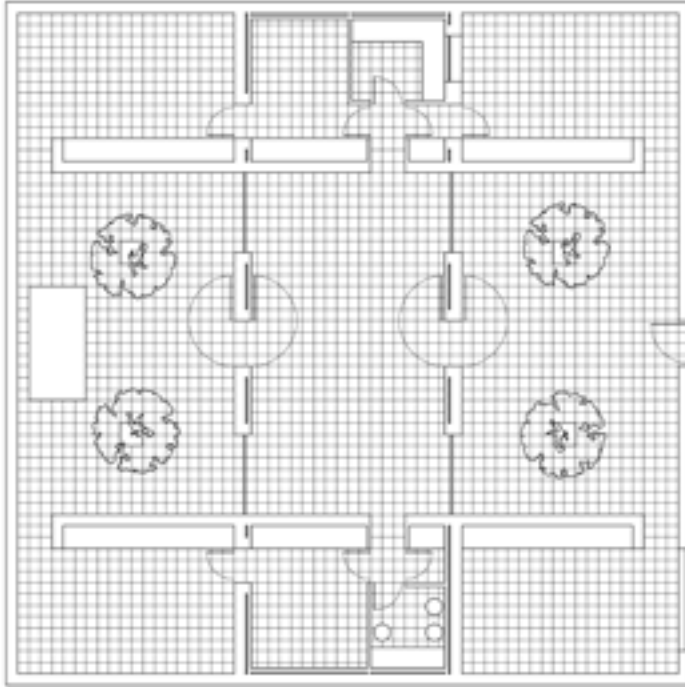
Casa Gaspar, Cádiz. 1992. Planta / Gaspar House, Cádiz. 1992. Plan.
